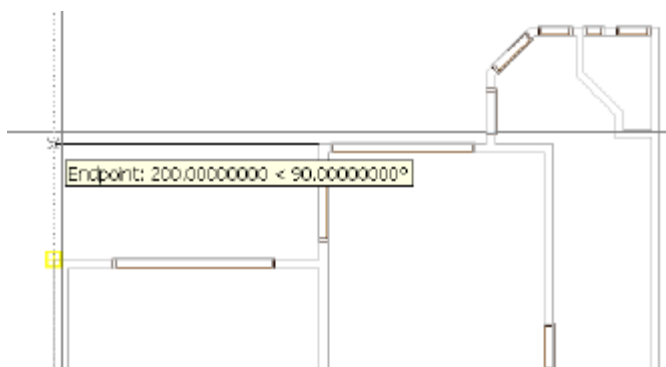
Utilização do recurso OTRACK para desenho da poligonal que define o piso do primeiro pavimento
